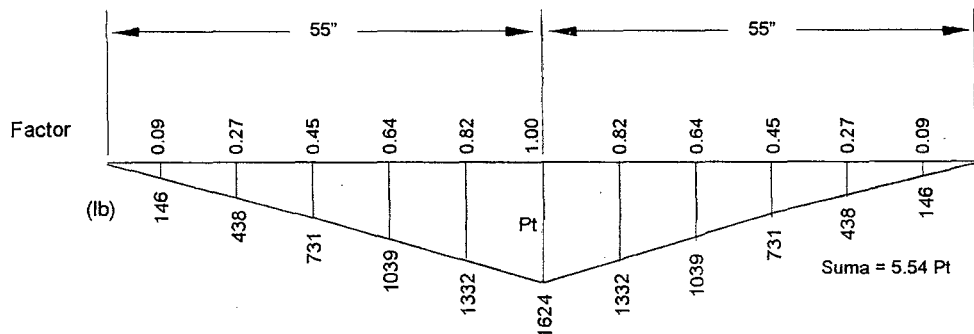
6 Fuerzas en las pasajuntas debido a la carga B.
